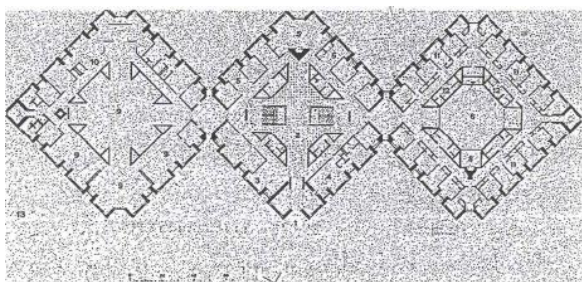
"Esboço e planta da Residencial Universitária E. Donnelly Erdman Hall, Pensilvania, 1960-65, Louis I. Kahn". (Serrano, 1992, p. 206)
